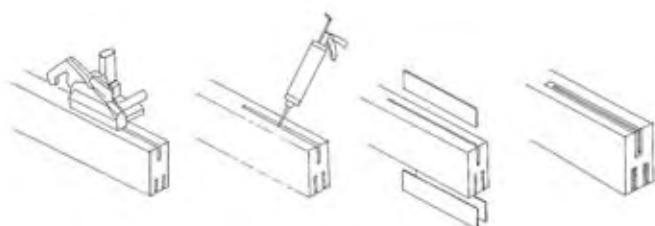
Execução do reforço de vigas com compósitos de FRP.
